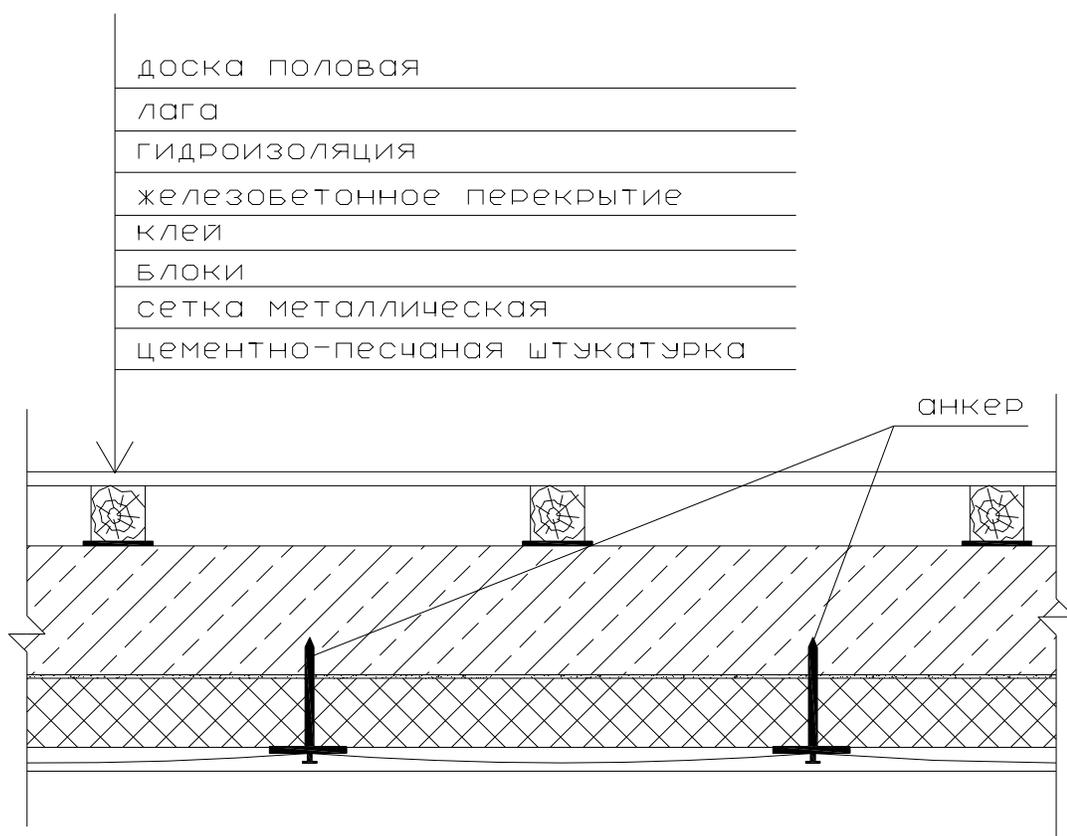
Наружная тепловая изоляция перекрытия с отделкой полимерминеральными материалами
